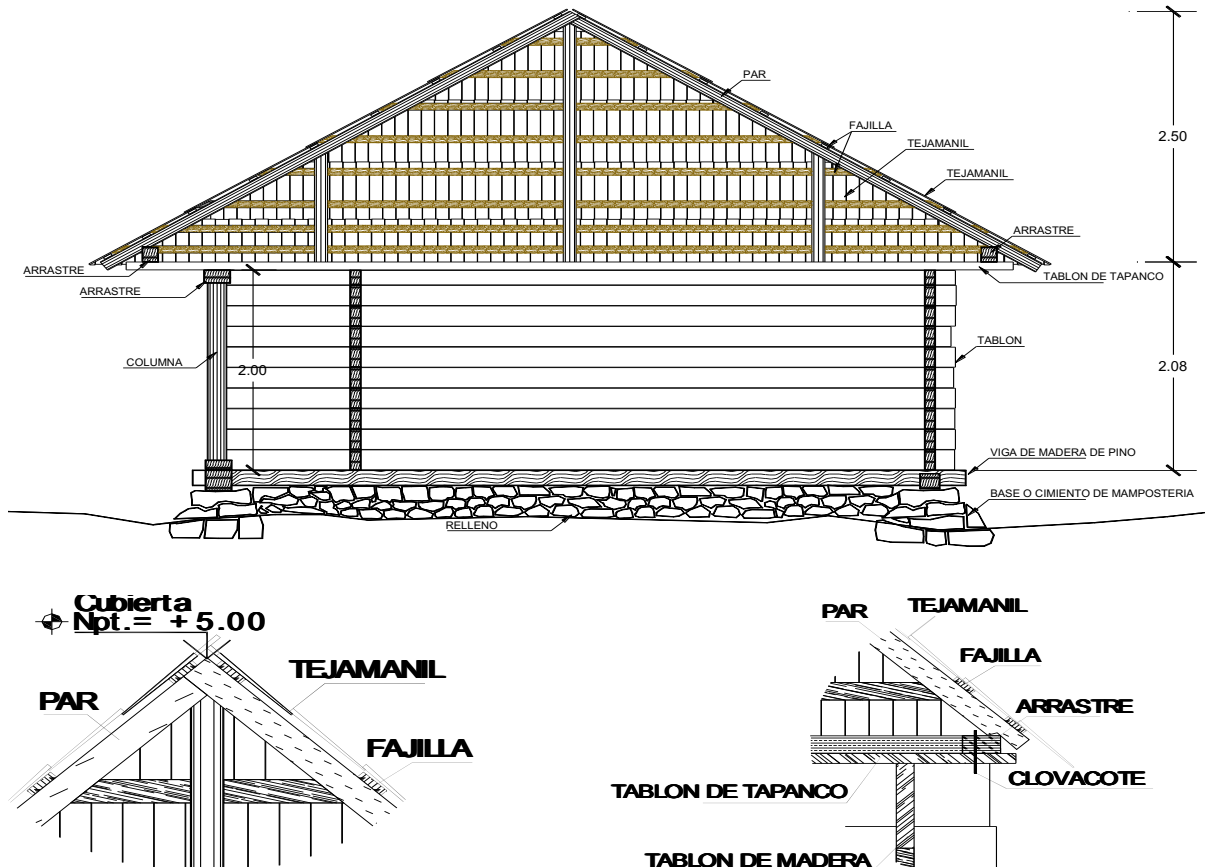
Corte Transversal de Troje y detalles de techumbre.
